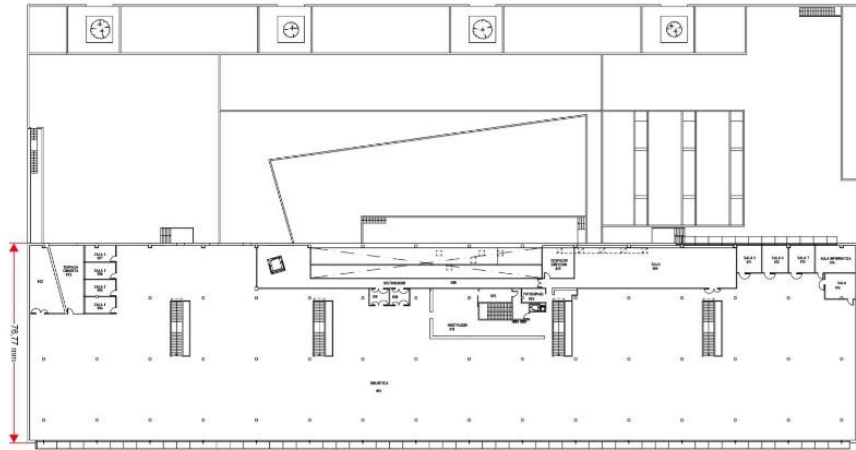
Medidas de las paredes de la segunda planta de la Biblioteca
